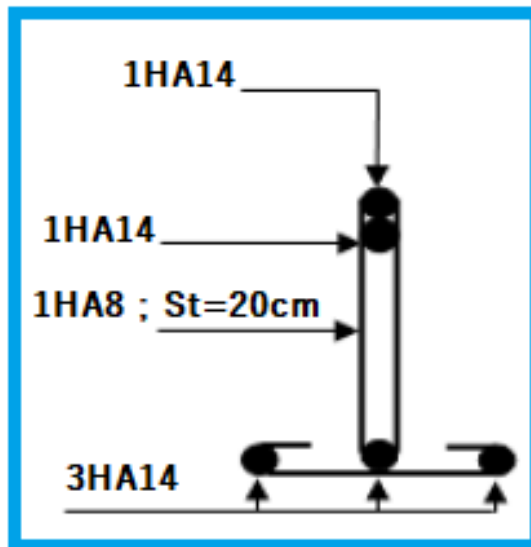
Schéma de ferrailage de la poutrelle étage courant.
